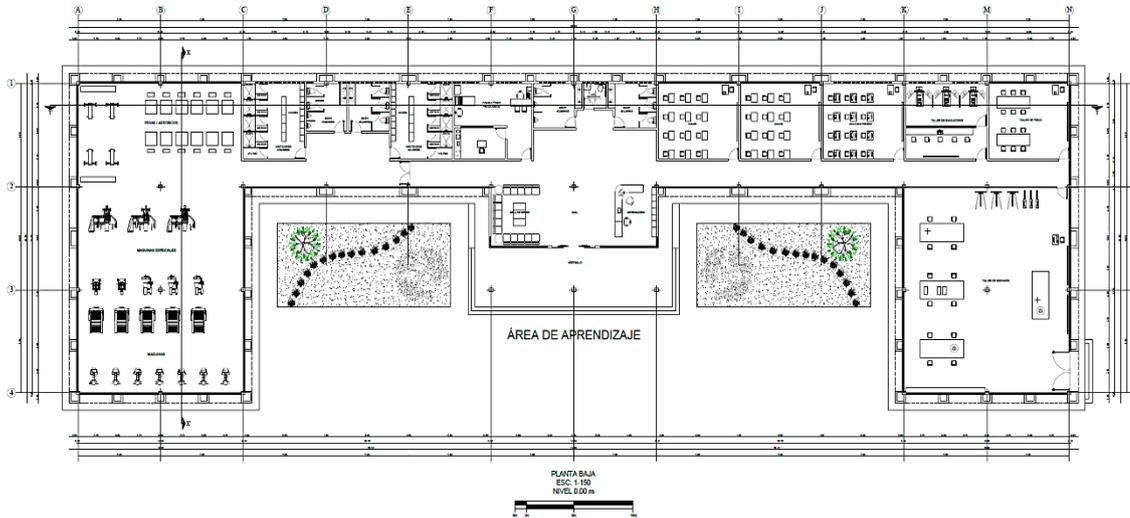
Plano arquitectónico de aprendizaje - escuela
